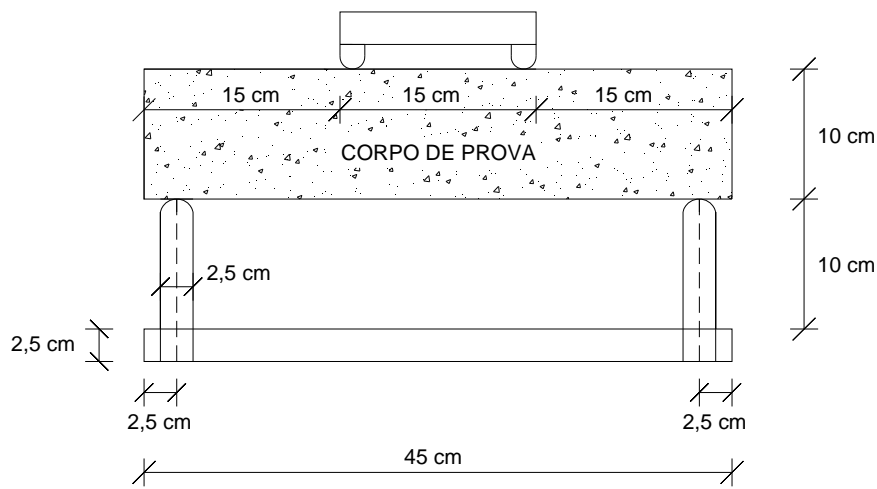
Ilustração esquemática do aparato para o ensaio de tração na flexão.
